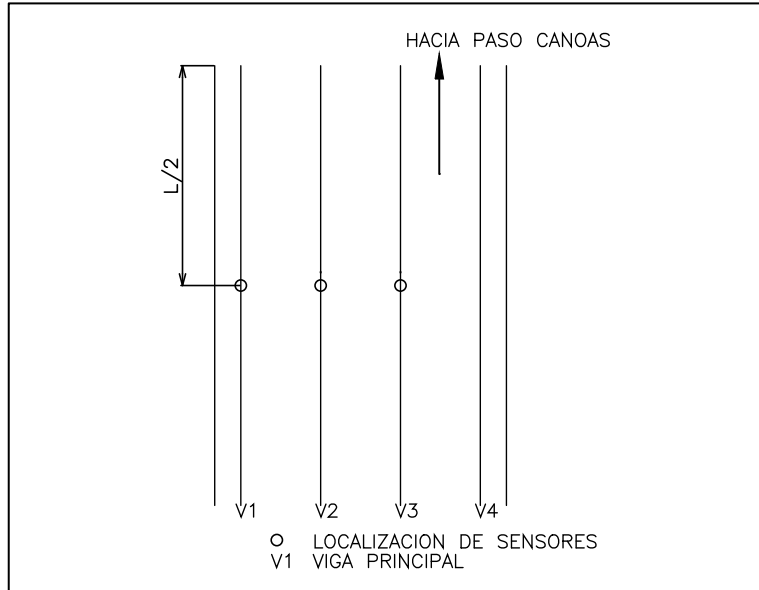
Sugerencia para la localización a $L/2$ del claro central de sensores sean LVDT o para deformación unitaria (strain gages) en planta para el puente Rio Olla Cinco. Fuente: propia.
